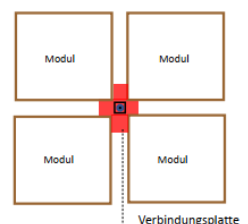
Verbindungsprinzip 2 - im Grundriss
